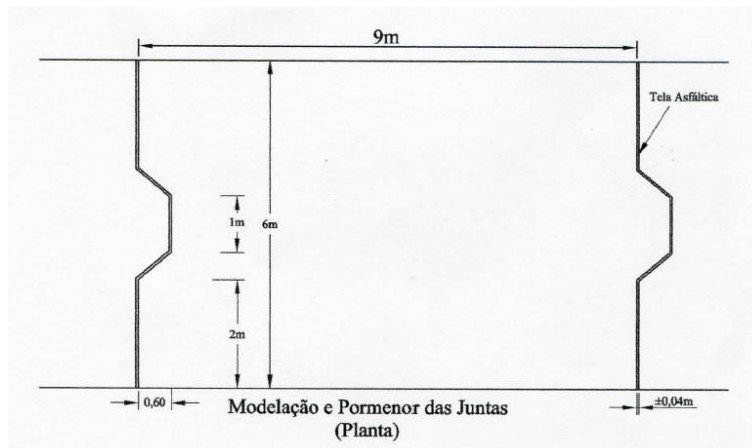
Planta da modelação e pormenor das juntas do quebramar destacado da Aguda (1999). [2]
